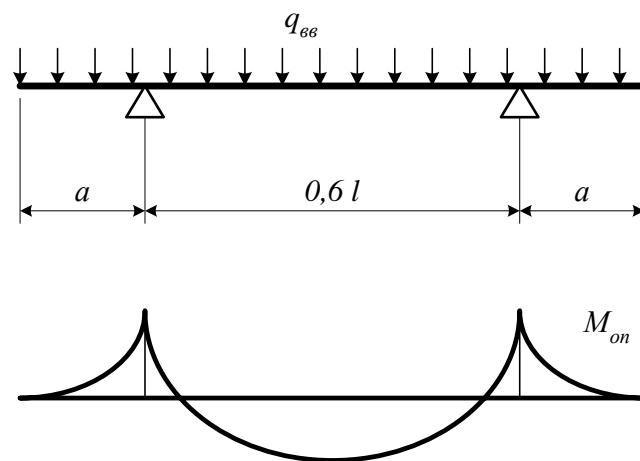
Розрахункова схема плити при підніманні, монтажі; епюра моментів
